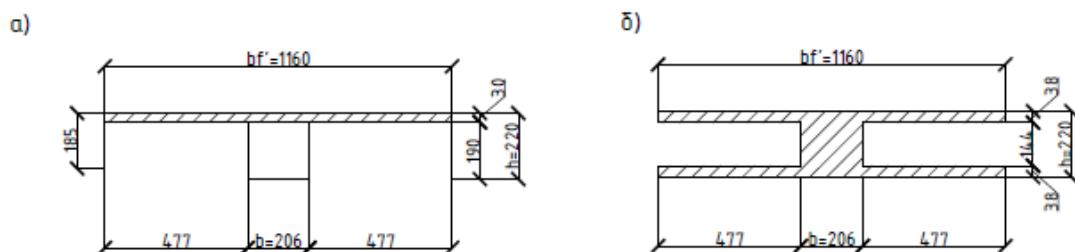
Схема эквивалентного сечения плиты перекрытия:
